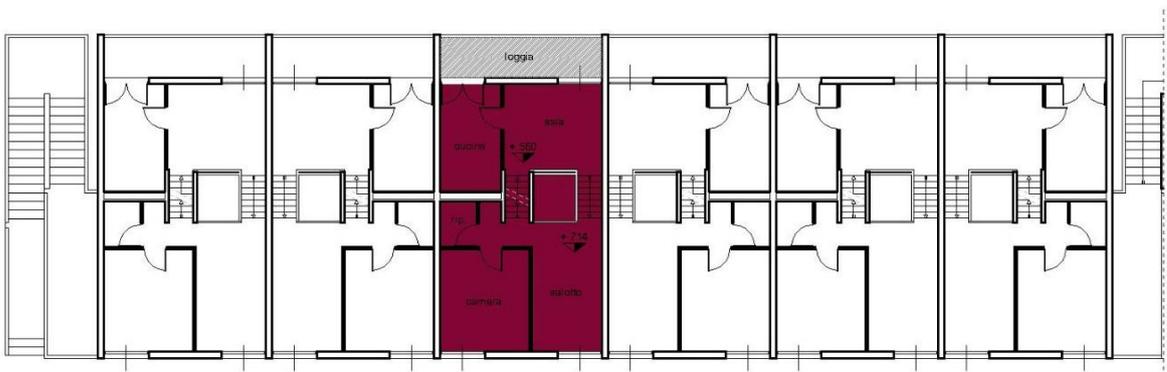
Pianta dell'appartamento 12 - 1 di 2
